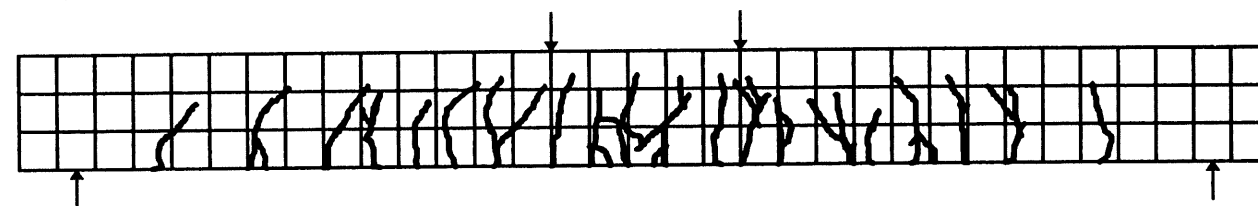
Réseau de fissuration de la poutre S900C
